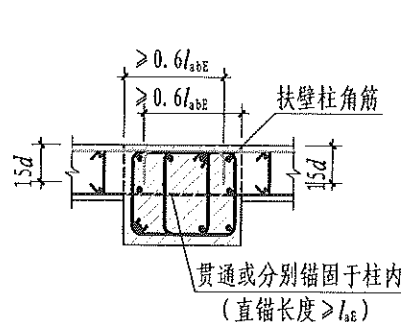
墙体水平钢筋在扶壁柱内锚固
